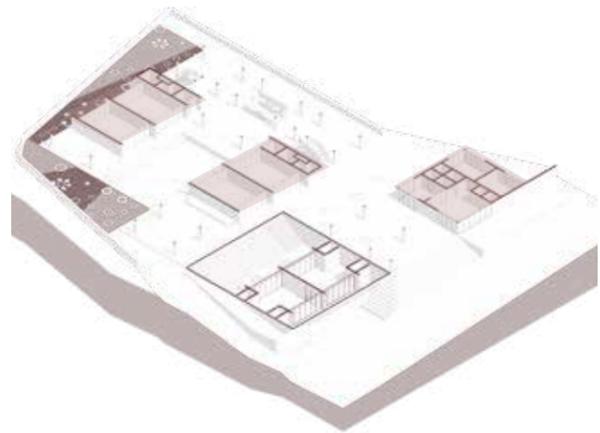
Axonometría emplazamiento Fuente: Elaboración propia.
